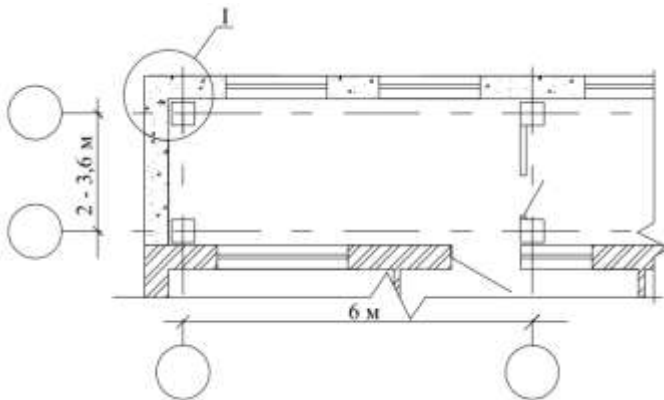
Фрагмент плана зоны А увеличения ширины корпуса пятиэтажного жилого дома
